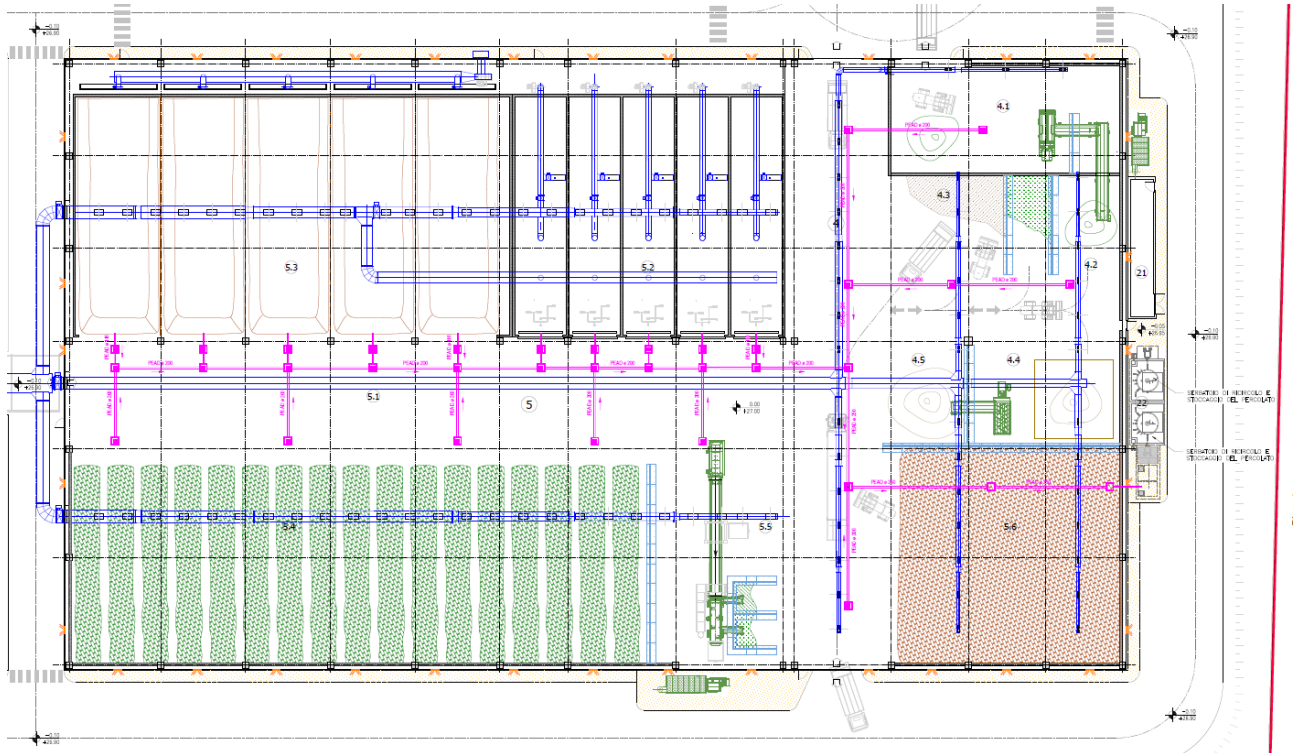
In magenta è rappresentata la rete raccolta acque processo. Stralcio planimetria 1137-D-I-PL-08-0
